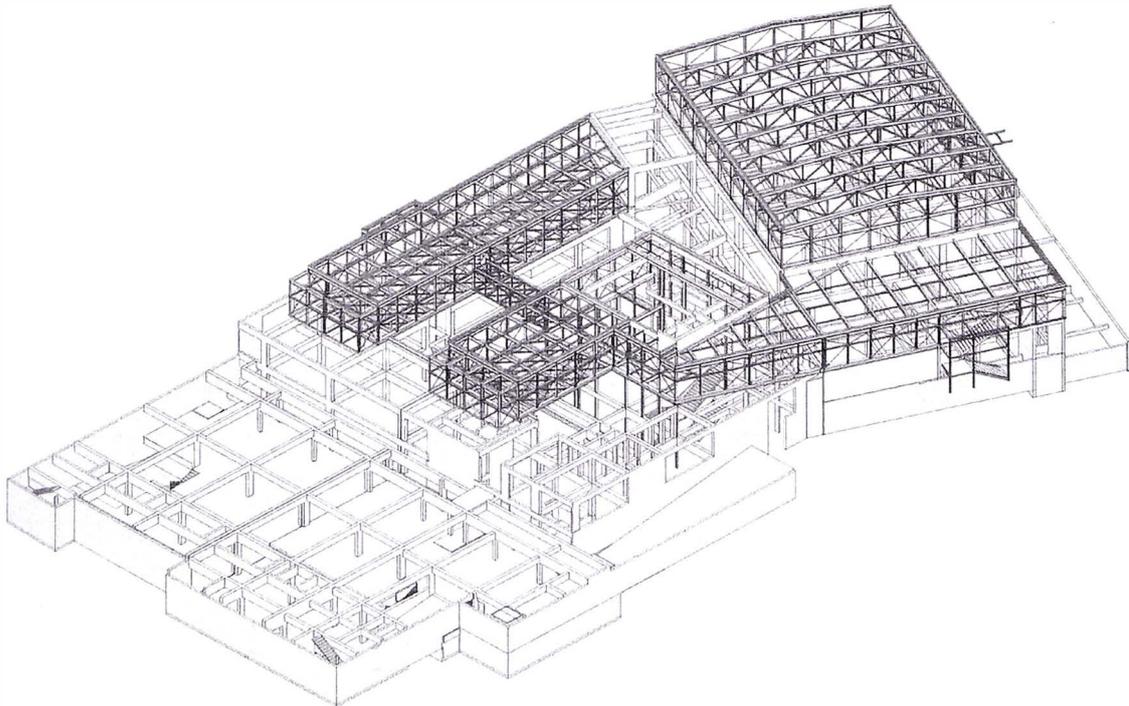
diseño estructural del proyecto, sistema mixto.
